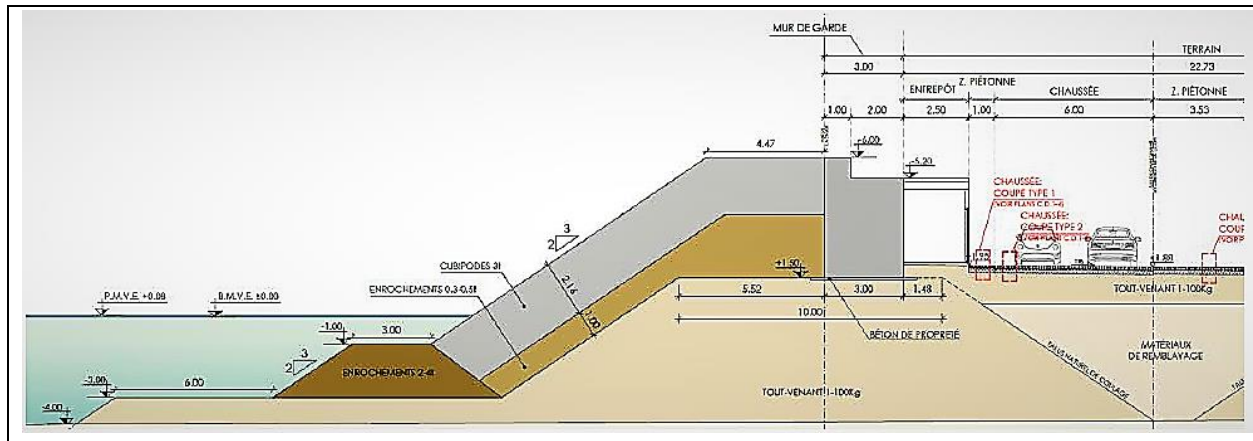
Coupe type de la section courante de la jetée principale. (BTP Infrastructuras., 2015)
